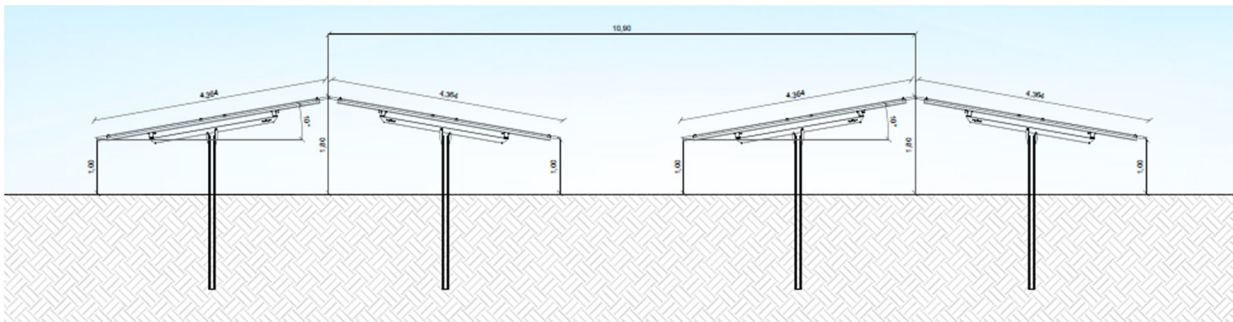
Sezione Tipo Strutture 2V (e-w)
